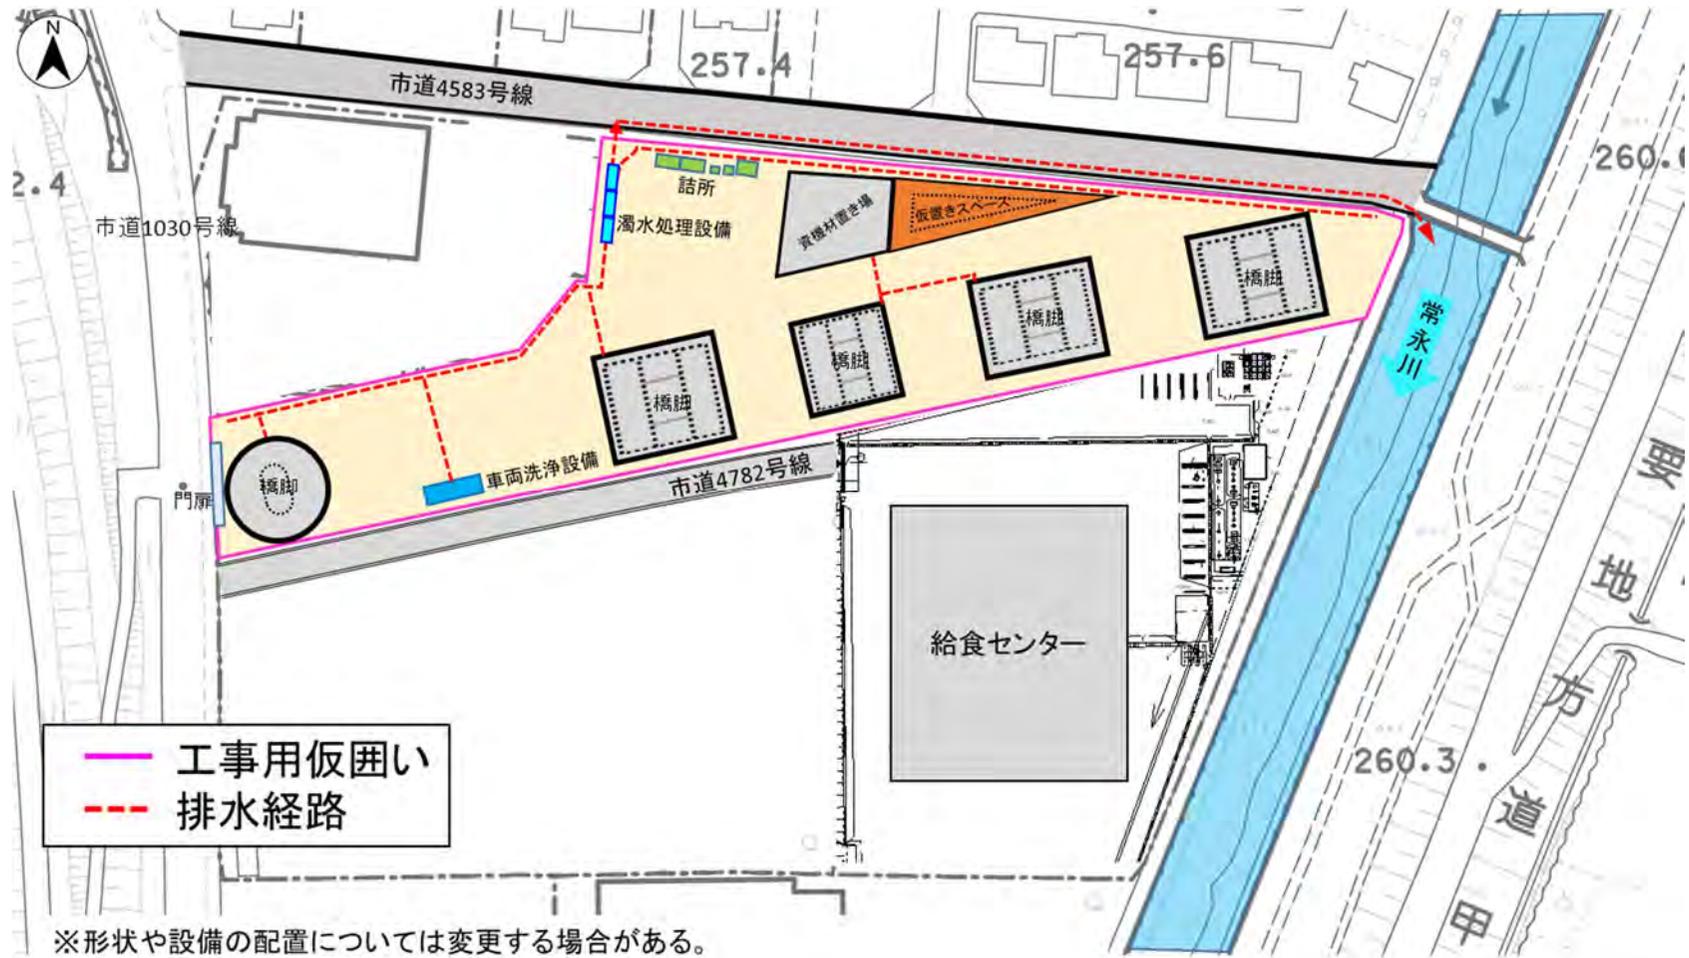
(1) 工事施工ヤード設備配置図 (釜無川右岸)
